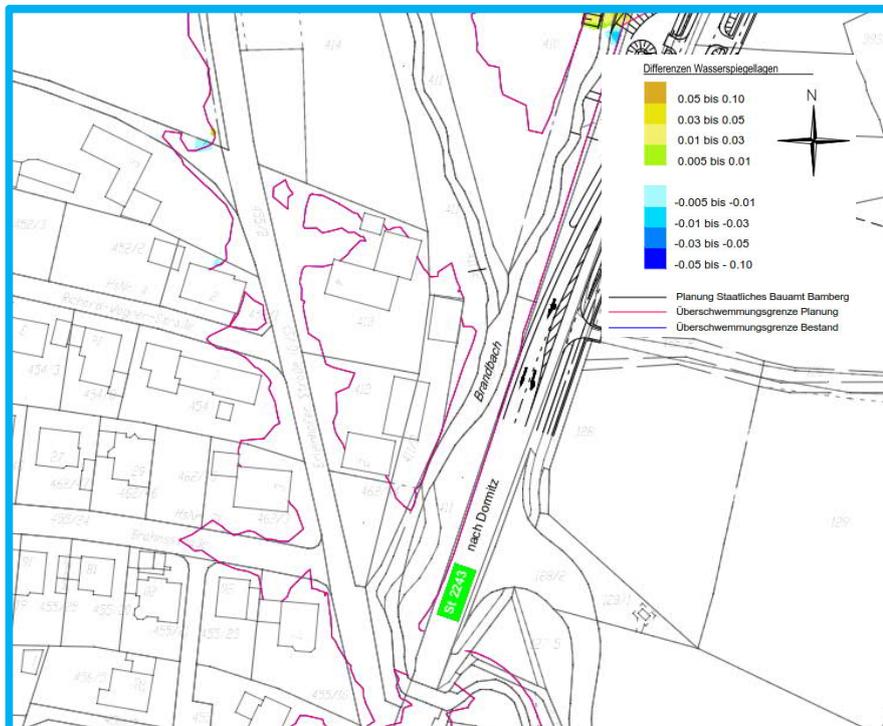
Differenzdarstellung Bestand – Planung, Ortslage Dormitz
